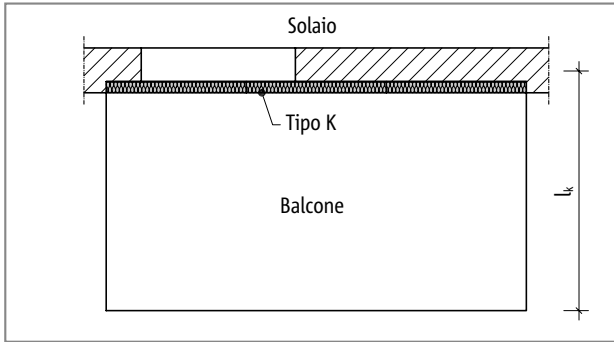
Schöck Isokorb® tipo K, balcone a sbalzo
